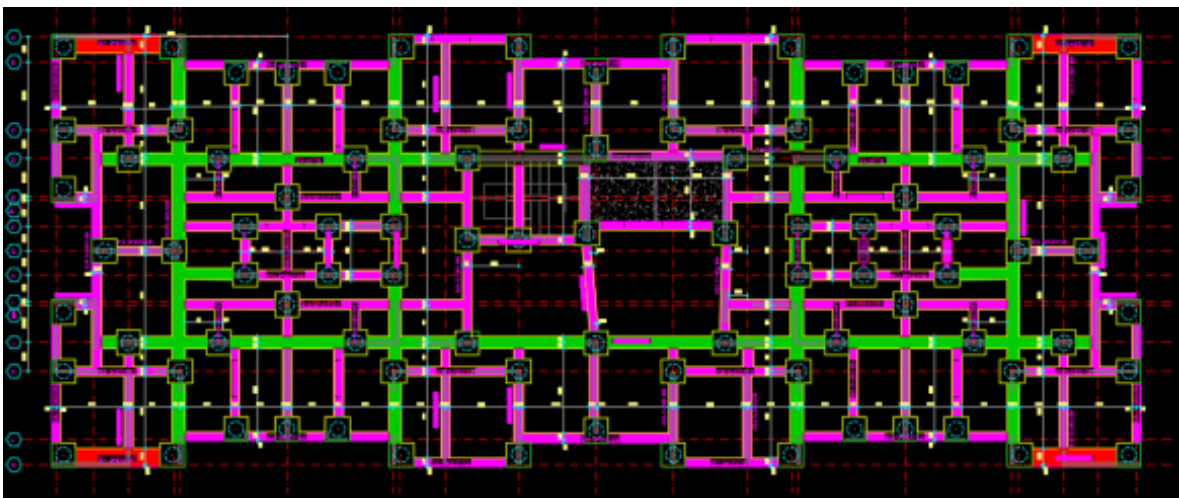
Planta de Cimentación, fuente Ingeniero Néstor Roncancio.
